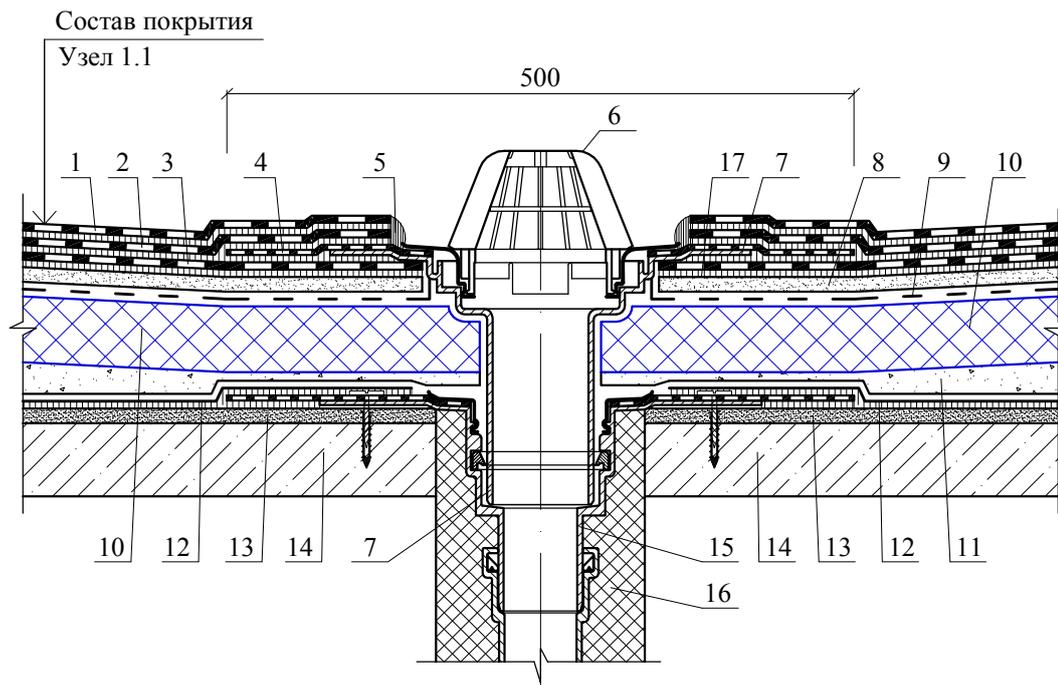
Примыкание кровли к "тёплой" трубе (Узел 10)
